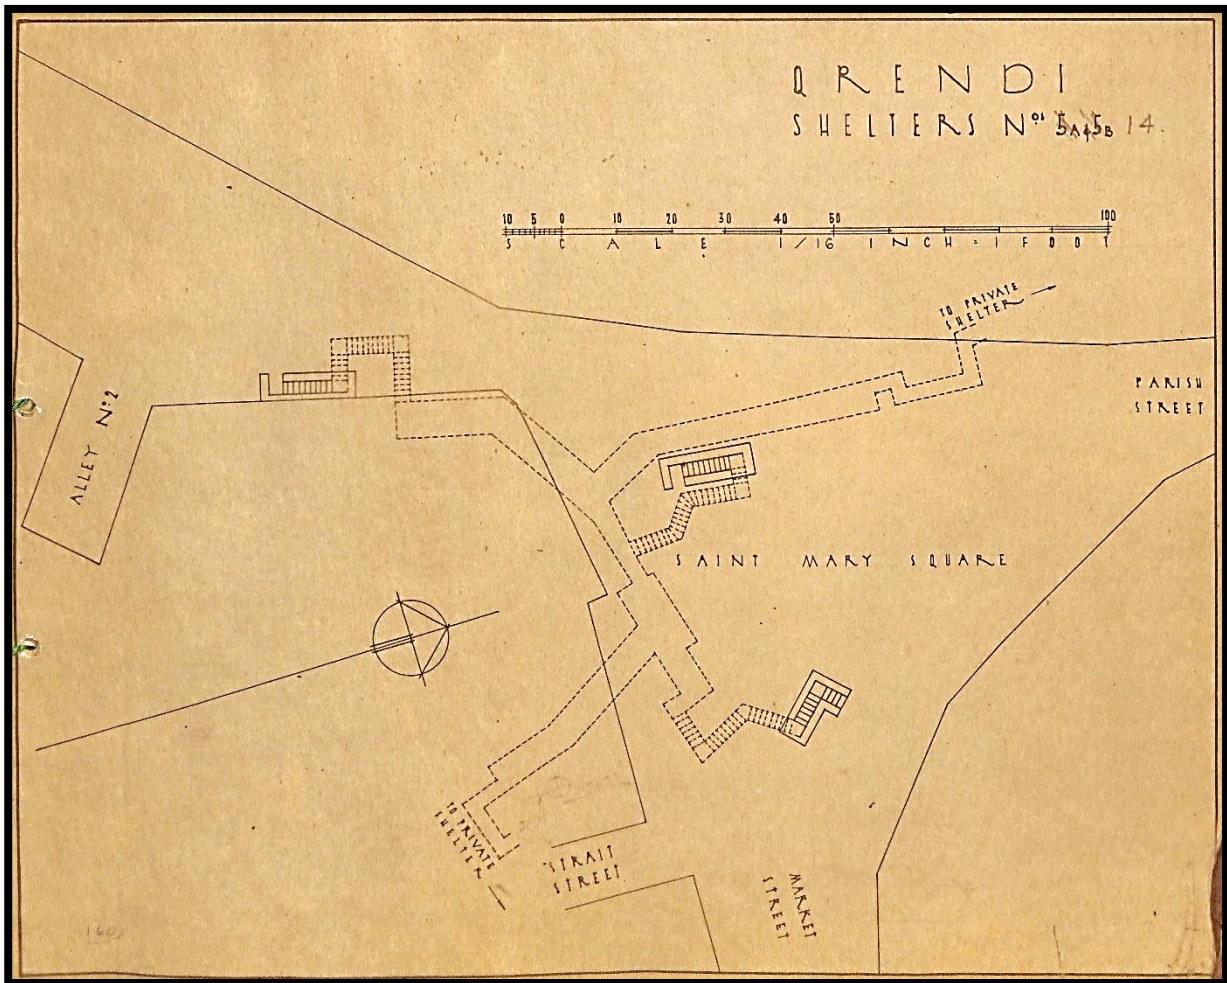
Planta do Abrigo nº14 "Saint Mary Square – Strait Street – Parish Church – Market Street – Alley nº2."
